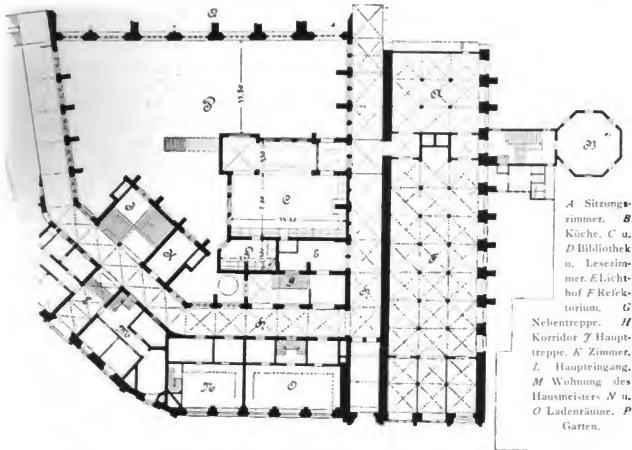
Grundriß des Erdgeschosses vom Domanbau. Heinr. Müller. 1876.
